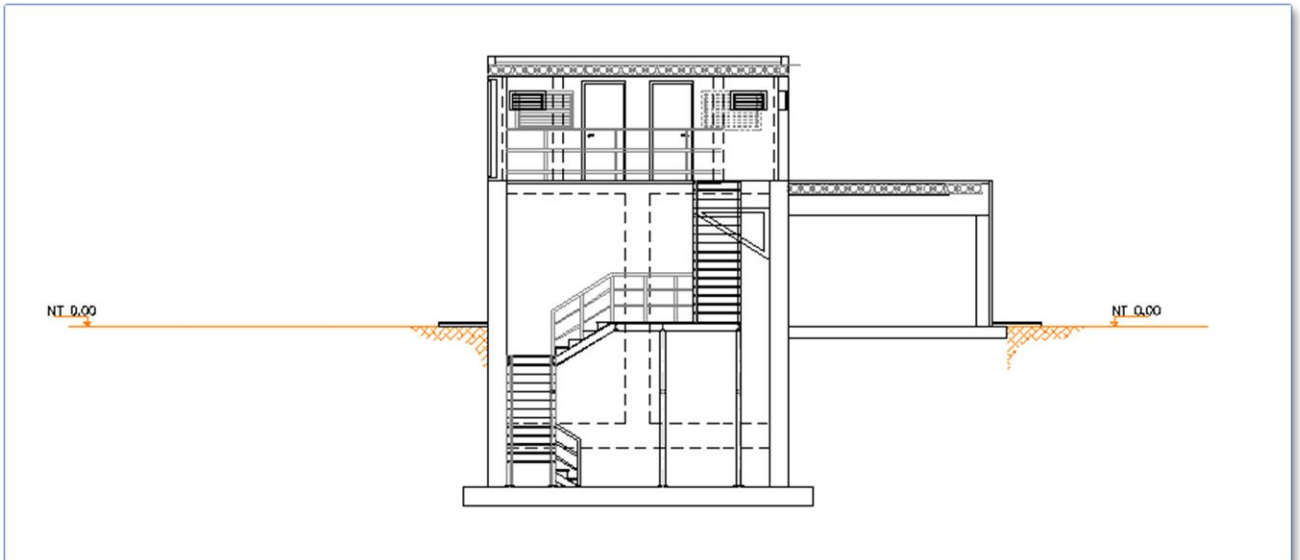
Acceso a cámaras en depósito existente. Sección transversal sala de válvulas.
